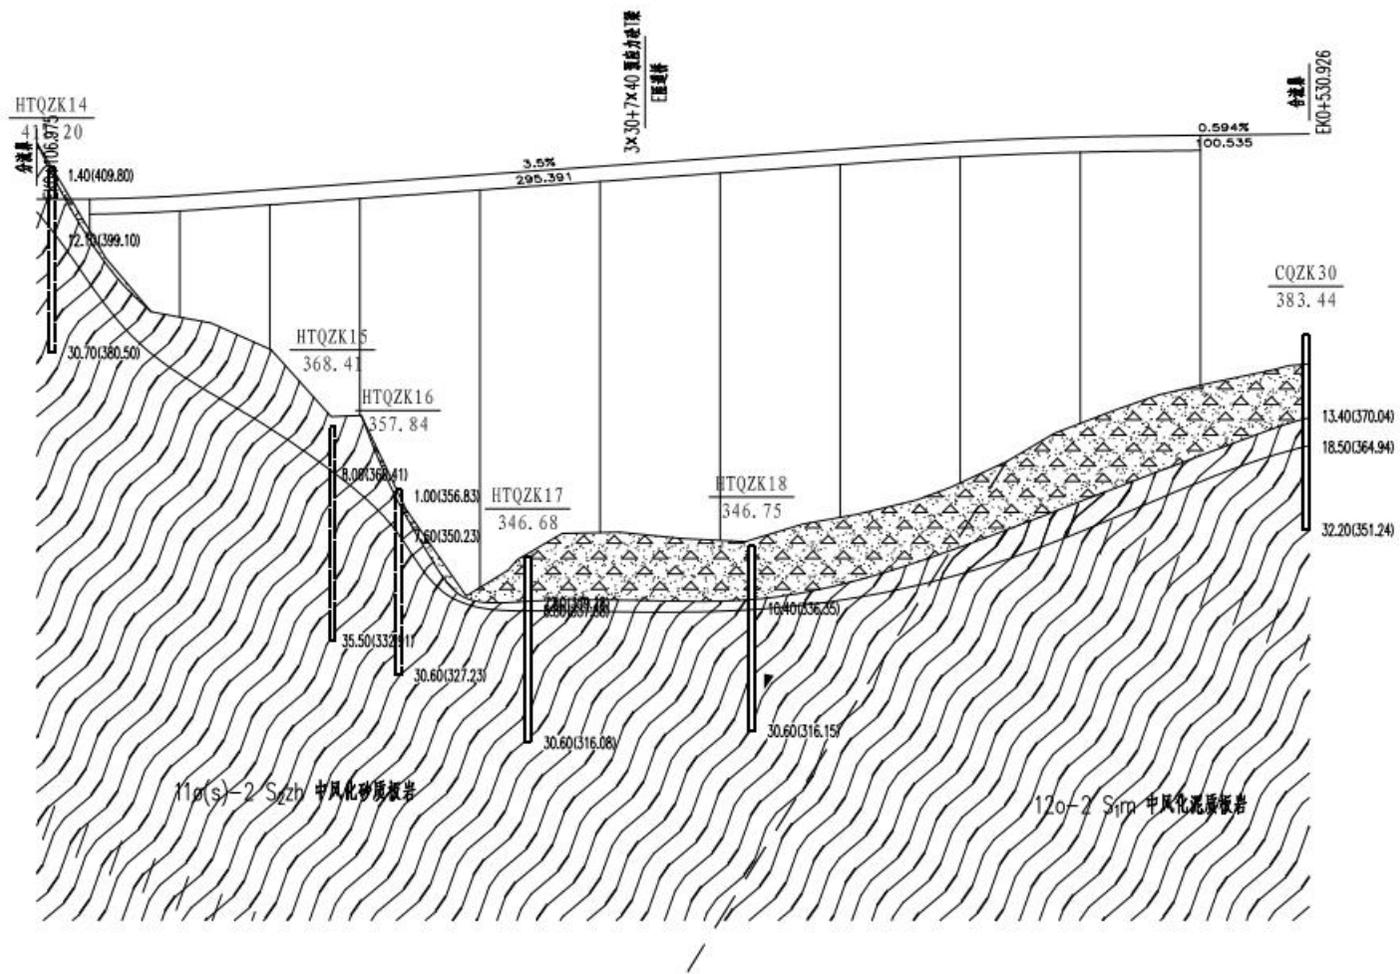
新洲互通 E 匝道桥桥址区地质纵断面图
